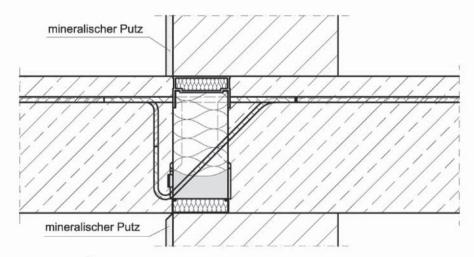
Schöck Isokorb® (F30/REI30) gem. Abschnitt 3.1.2
